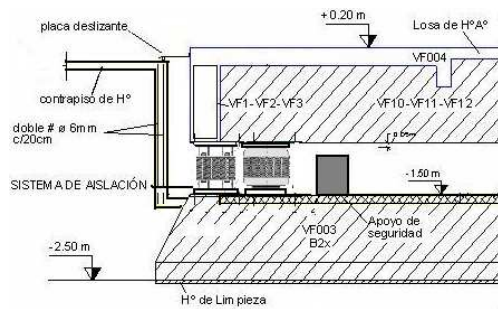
Dispositivos del sistema de aislamiento posicionado debajo del edificio.
